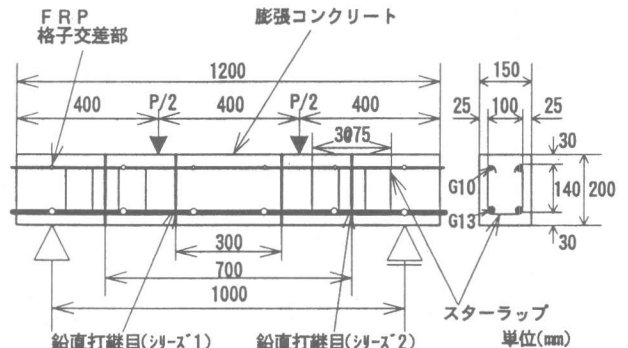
はり供試体の断面形状寸法と載荷方法 (FRP: 格子間隔20cm)
